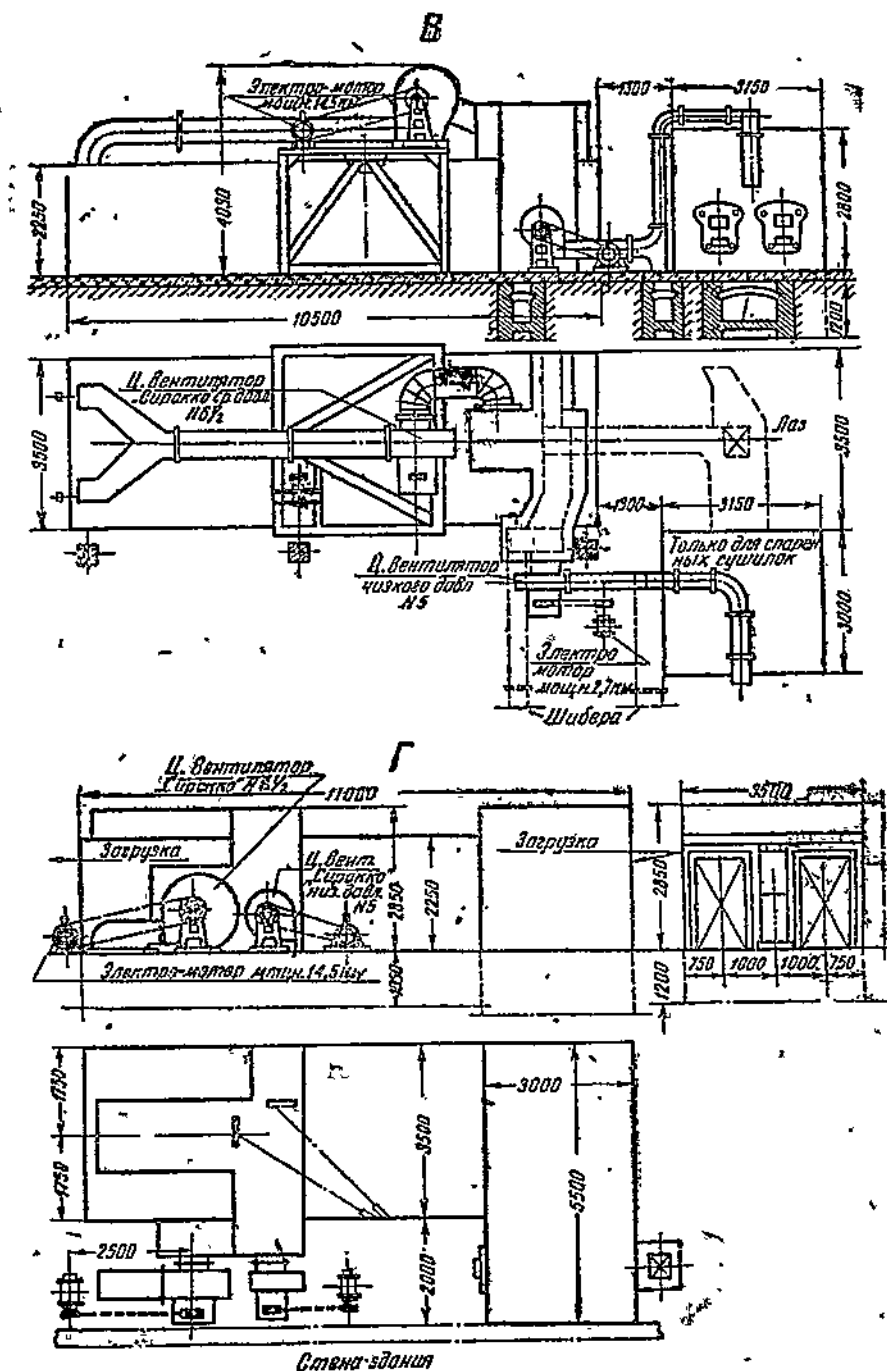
Схема взаиморасположения основных устройств сушилок ФТД-ВНИИХ:
